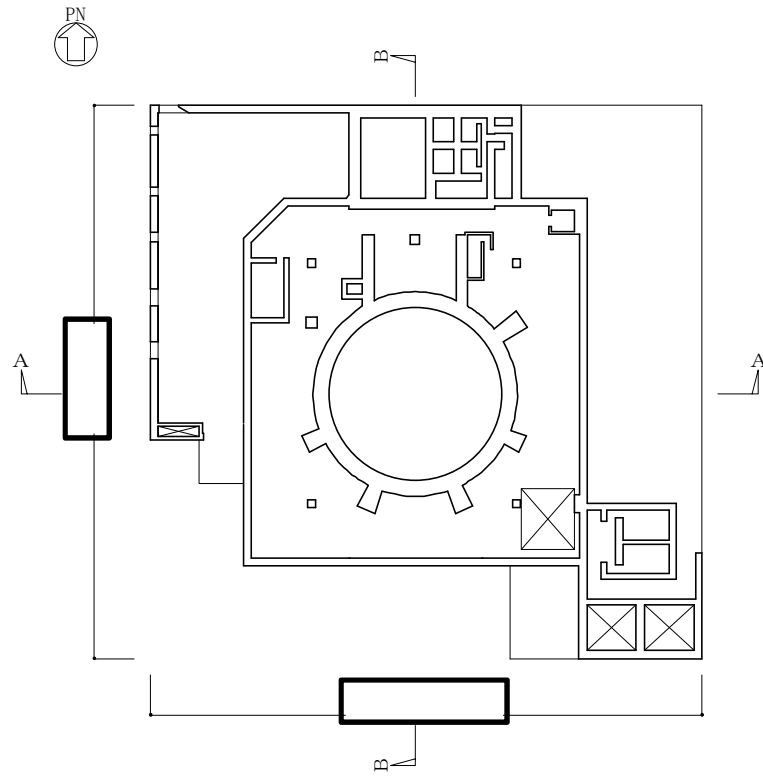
(5/10) 原子炉建屋の概略平面図 (EL. 20.3 m)
